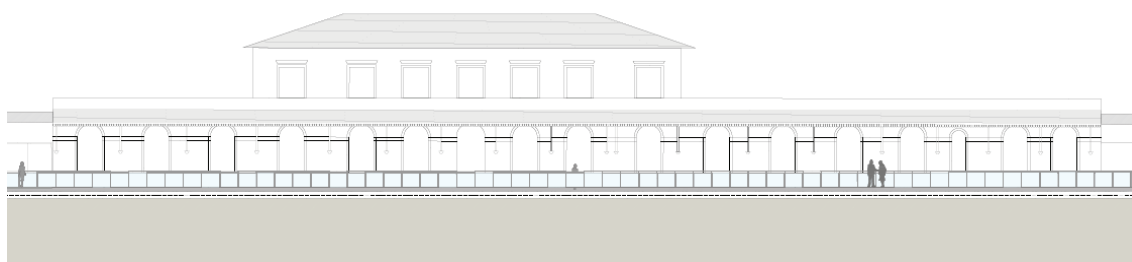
Prospetto Fabbricato viaggiatori esistente a seguito dell'innalzamento
